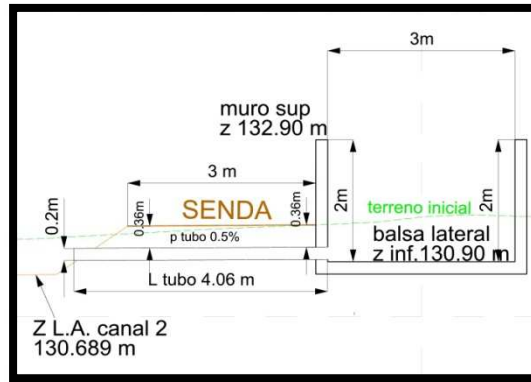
Perfil detalle conexión balsa lateral con canal 2.
